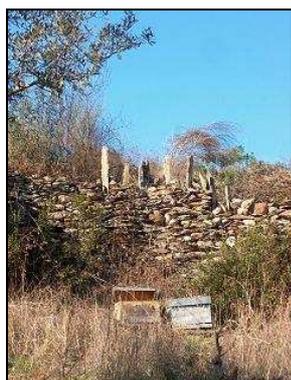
Presença de lajes verticais no beirado (sem explicação aparente).
